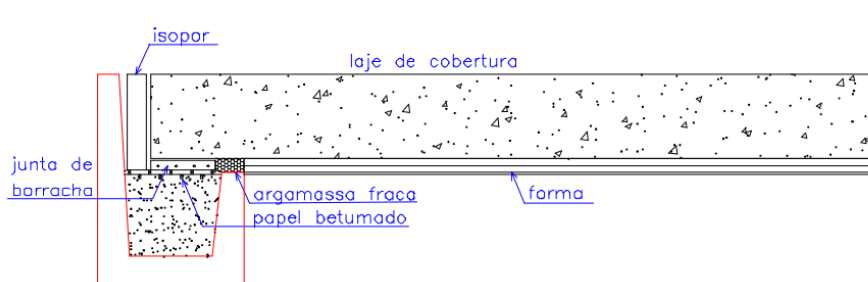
Detalhe da laje de cobertura (apoio deslizante)
